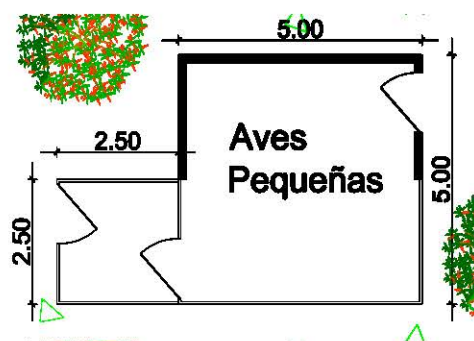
Planta arquitectónica de jaula para rehabilitación de aves pequeñas.
